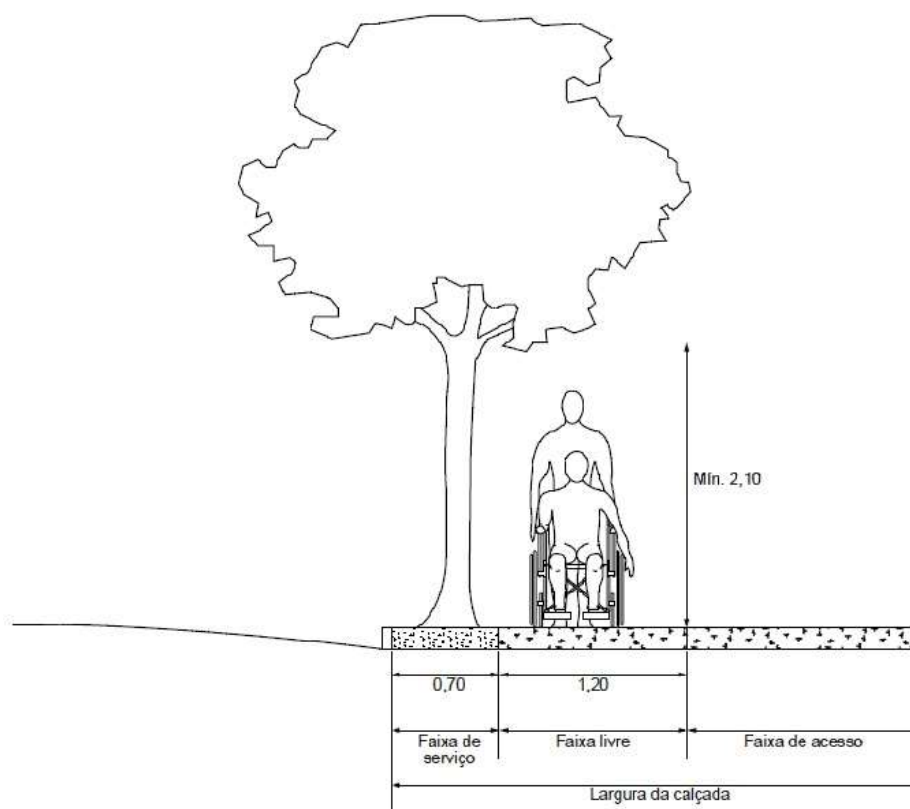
Faixas de uso da calçada, em corte (Fonte NBR 9050)
